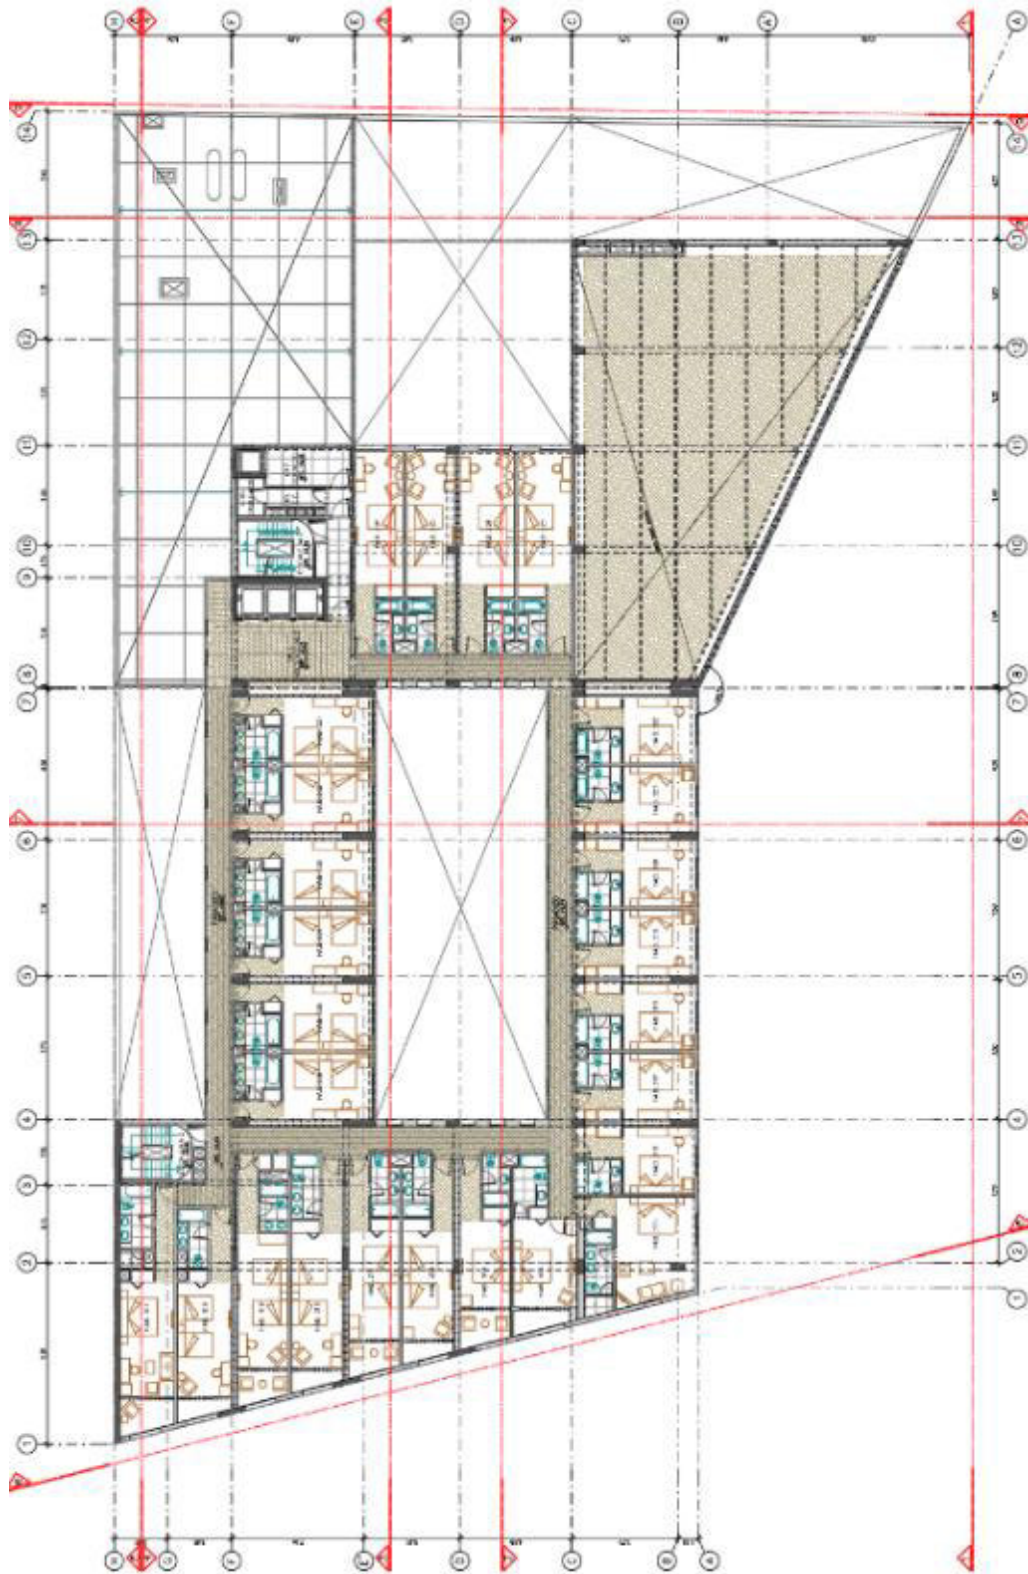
Planta Tercer Piso del Proyecto.Nota. Elaboración propia.
